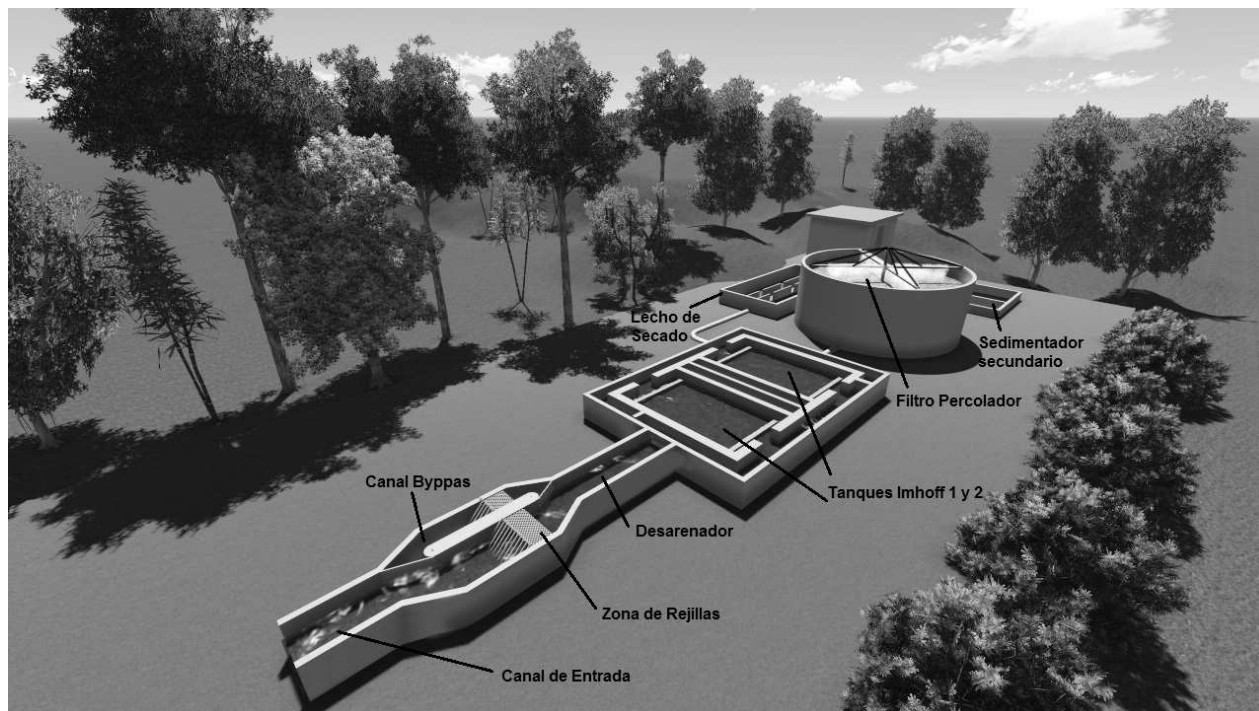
Vista en planta de la PTAR nueva de la UCLV.
